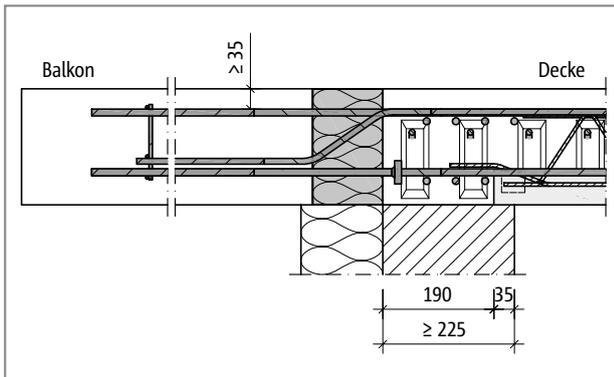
Schöck Isokorb® Typ EXT: Elementplatte ohne Randunterstützung mit WDVS (Schnitt EXT-L-CV35, Ansicht EXT-R-CV50)
